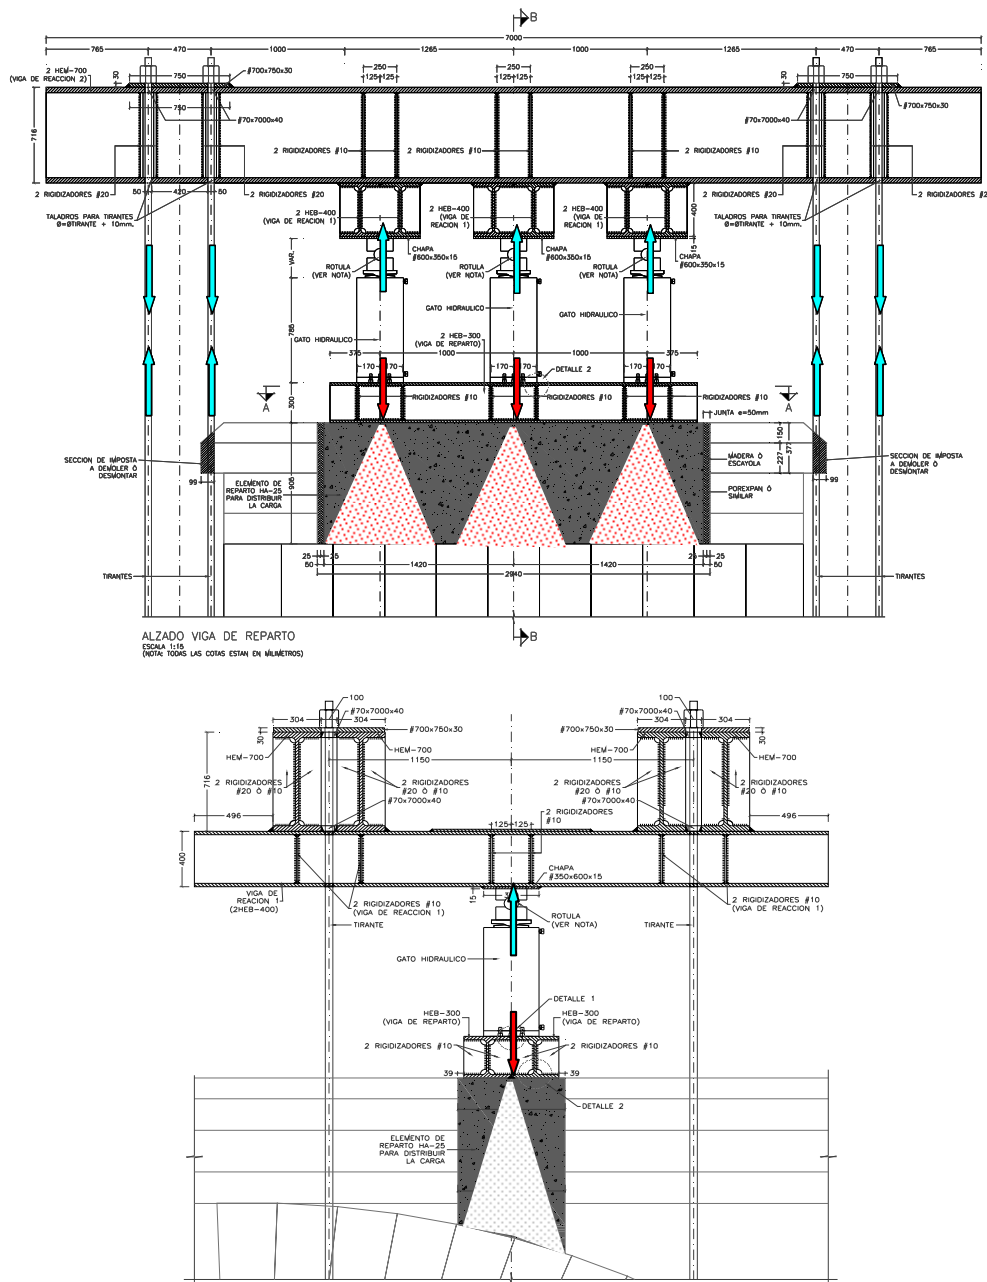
Secciones longitudinal y transversal de la bóveda de ensayo y vista del dispositivo de aplicación de la carga. Se representa el reparto de la carga con un ángulo de 30°, materializado con un elemento de hormigón aislado de los tímpanos.
